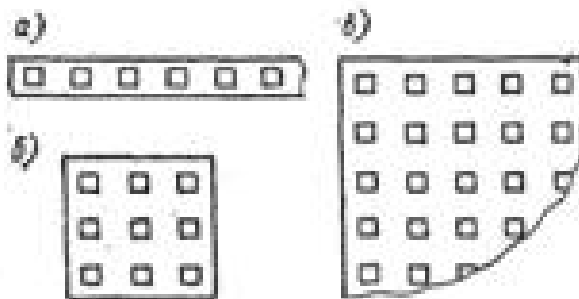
Виды свайных фундаментов в зависимости от размещения свай в плане: а – ленточный; б – свайный куст; в – сплошное свайное поле
